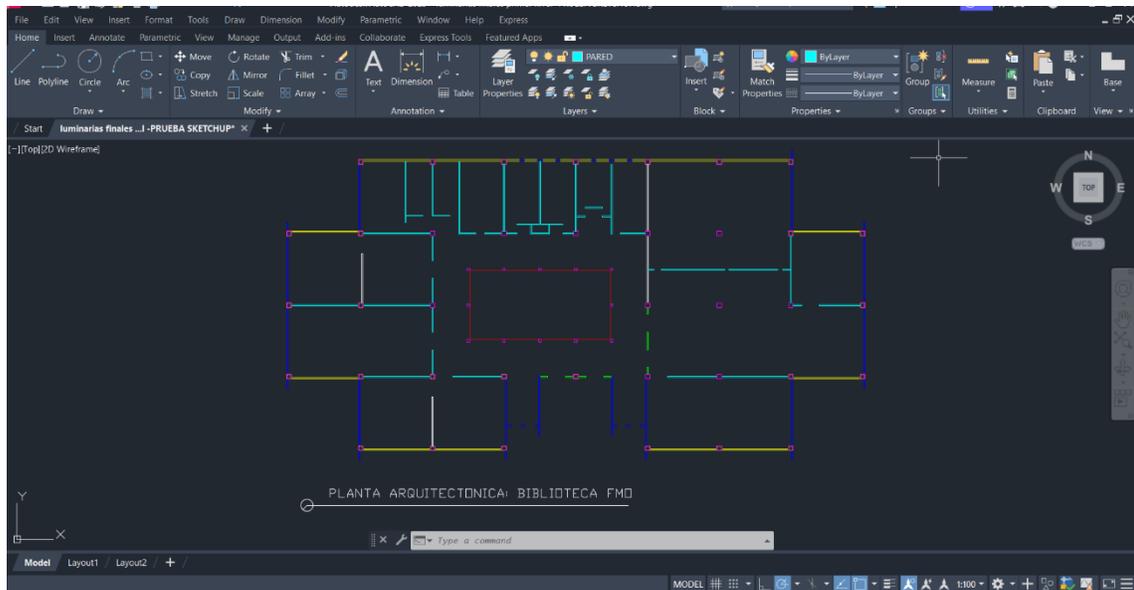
Vista en planta arquitectónica del edificio Unidad Bibliotecaria de la Universidad de El Salvador Facultad Multidisciplinaria Oriental
